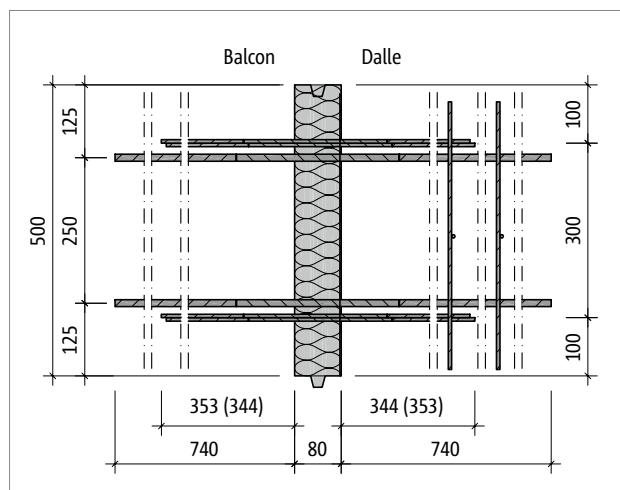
Schöck Isokorb® T type D-MM1-VV1 : plan de base
